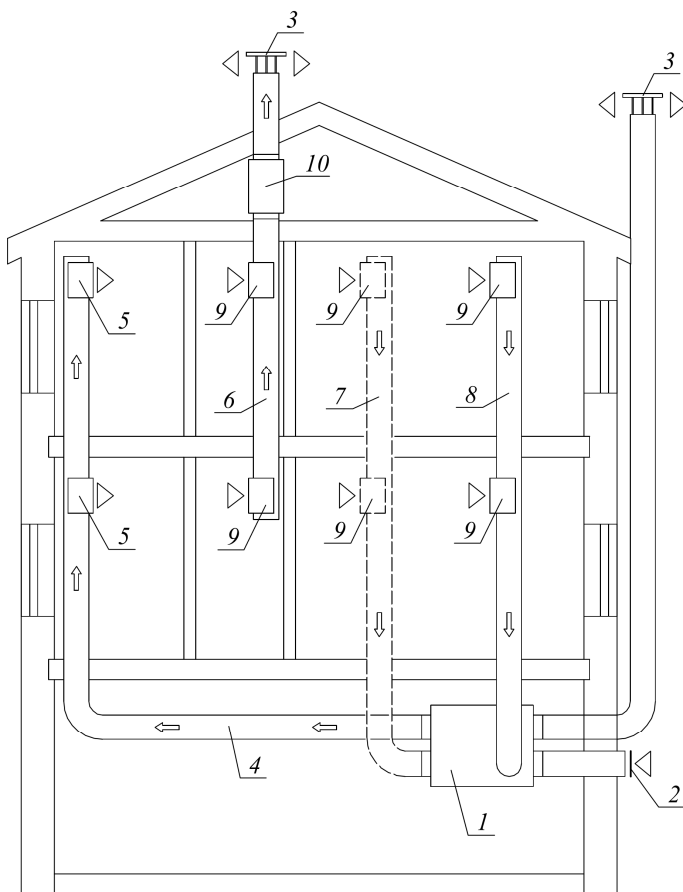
Схема воздушного отопления: 1 – приточно-вытяжная установка; 2 – воздухозаборная решетка; 3 – зонт-колпак; 4 – приточный воздуховод; 5 – приточная решетка; 6 – вытяжной воздуховод; 7 – вентканал к рекуператору; 8 – рециркуляционный воздуховод; 9 – вытяжные решетки; 10 – вытяжная установка
